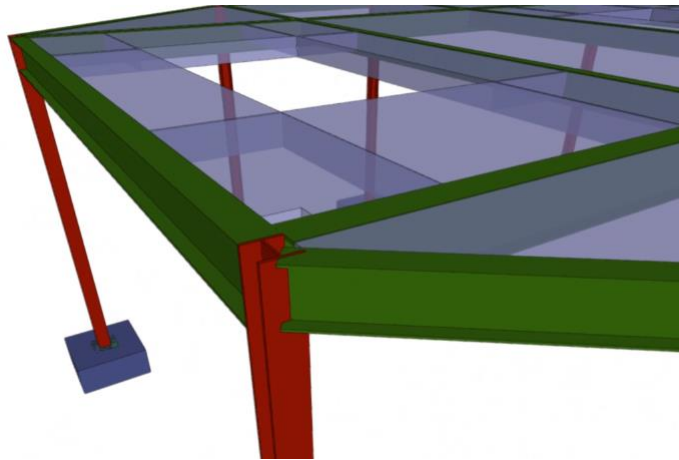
Uniones entre vigas y pilar. Orientación de pilares hacia dentro de la estructura
